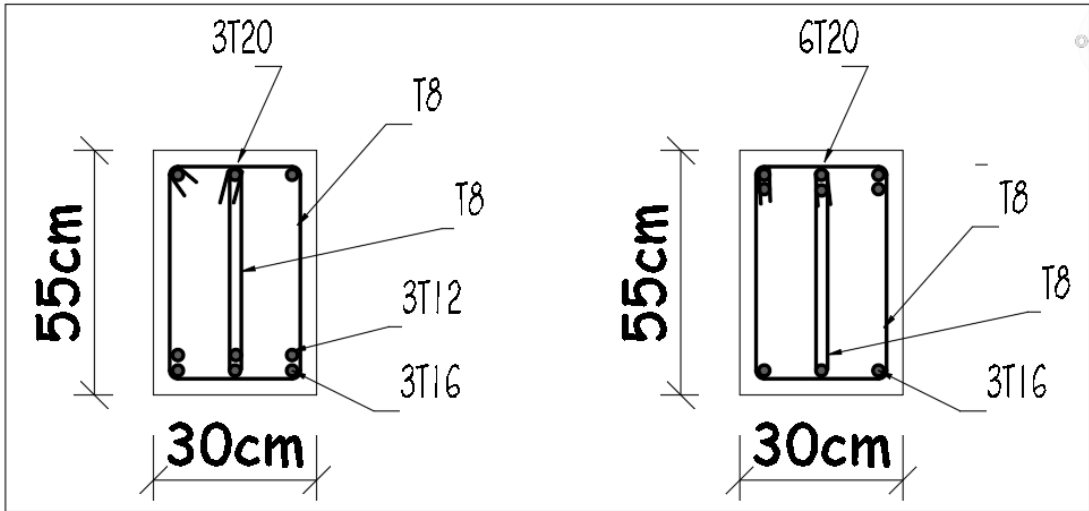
Ferraillage de la poutre principale du 3^{ème} au 5^{ème}
